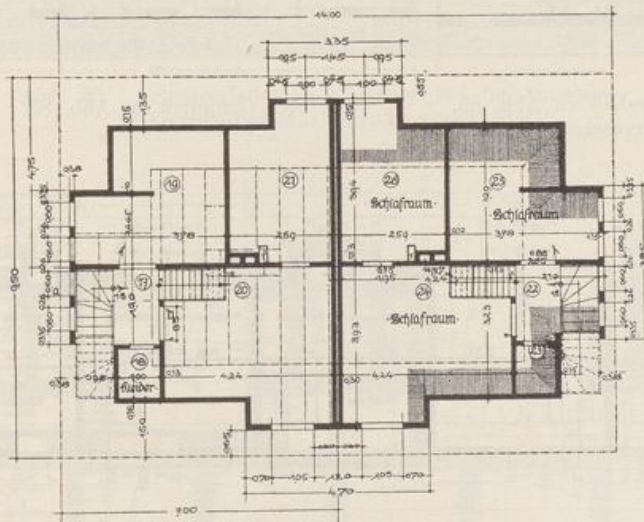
Grundriß zu Abb. 80. Obergeschoß.
